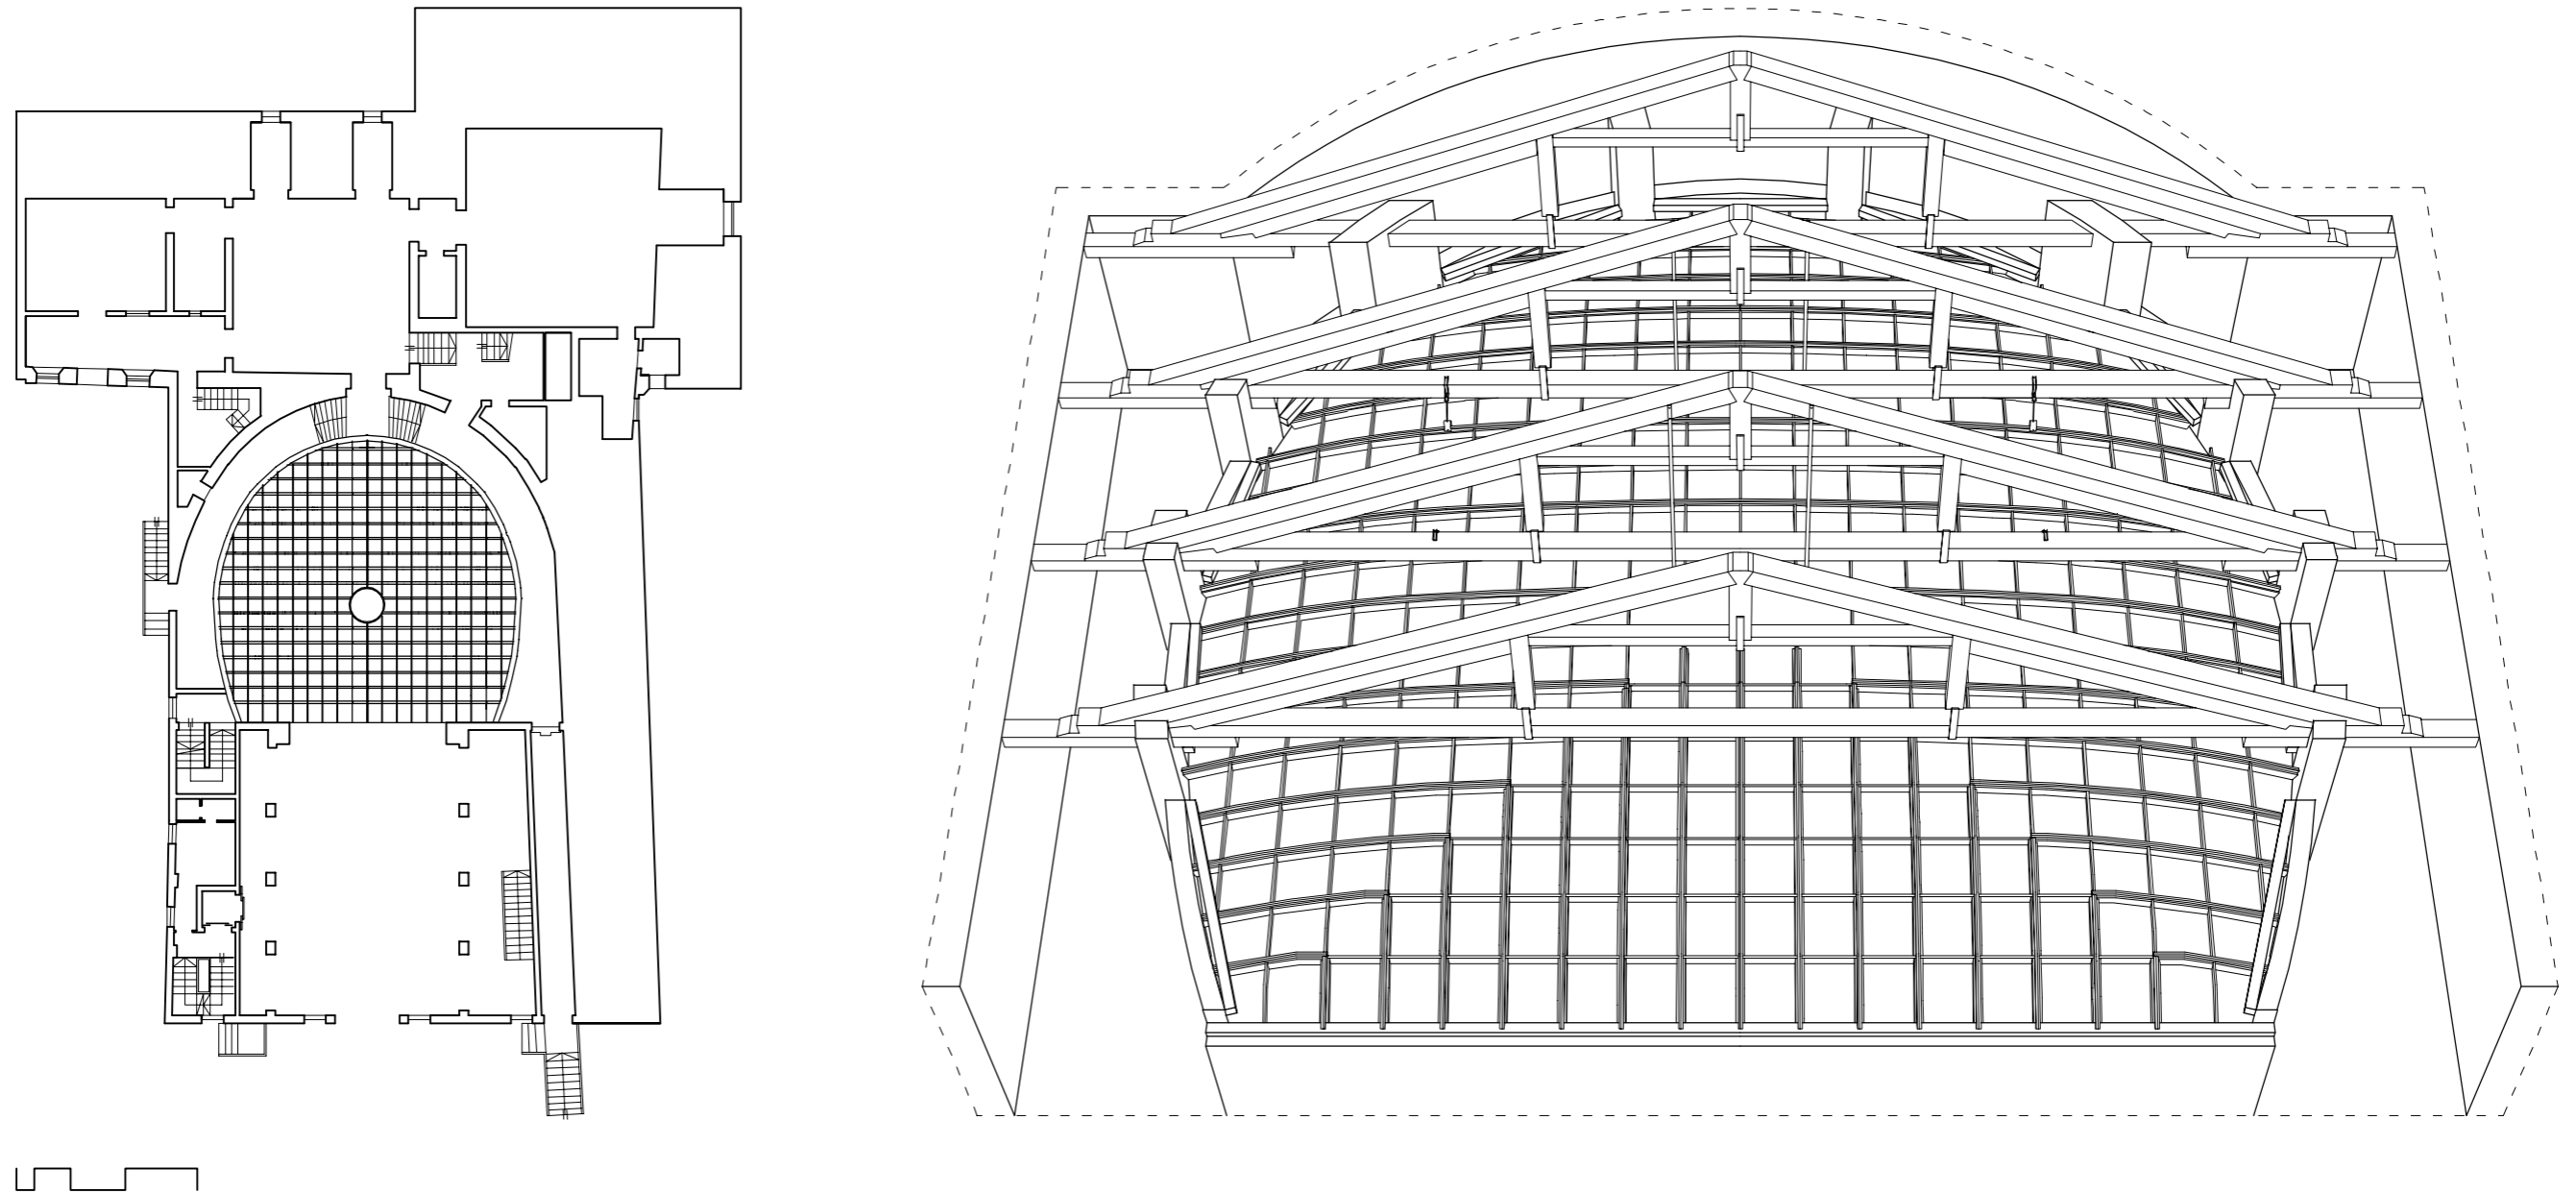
Teatro "Franco Tagliavini" di Novellara. Pianta del primo ordine di palchi (ridisegno) con proiezione del plafone; rappresentazione prospettica del sistema di copertura della sala.
